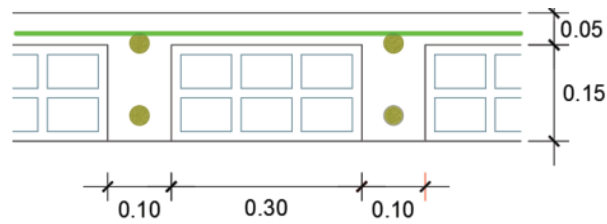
Predimensionamiento de losa aligerada*1.11.2. Predimensionamiento de vigas
